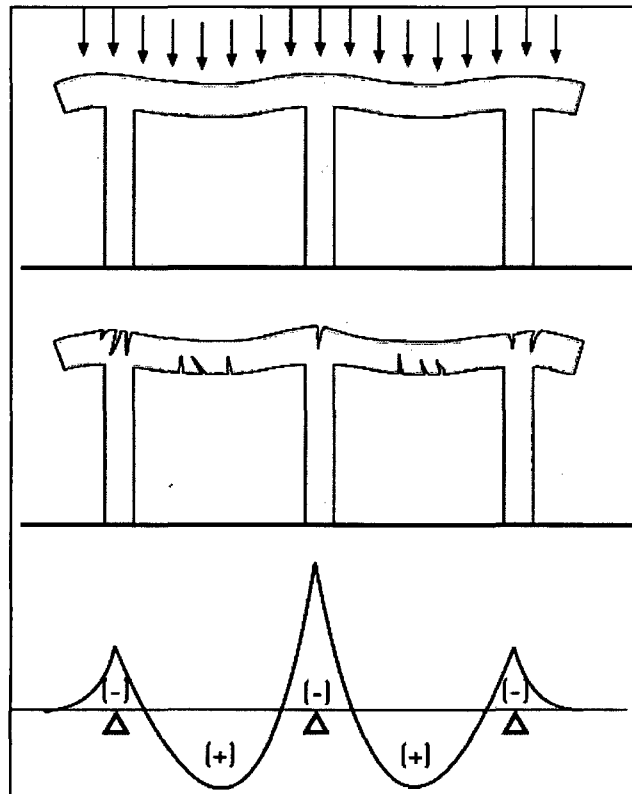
Esquema de fisuración de las vigas de un Pórtico de concreto armado debido a la flexión (Broto, 2004).
